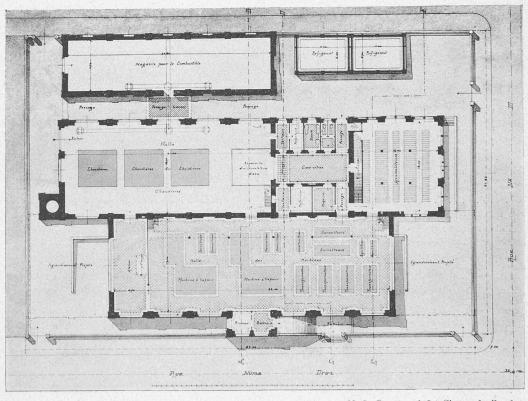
Projet « Edison ». — Plan du rez-de-chaussée. — Architecte : M. L. Reutter, à La Chaux-de-Fonds.
